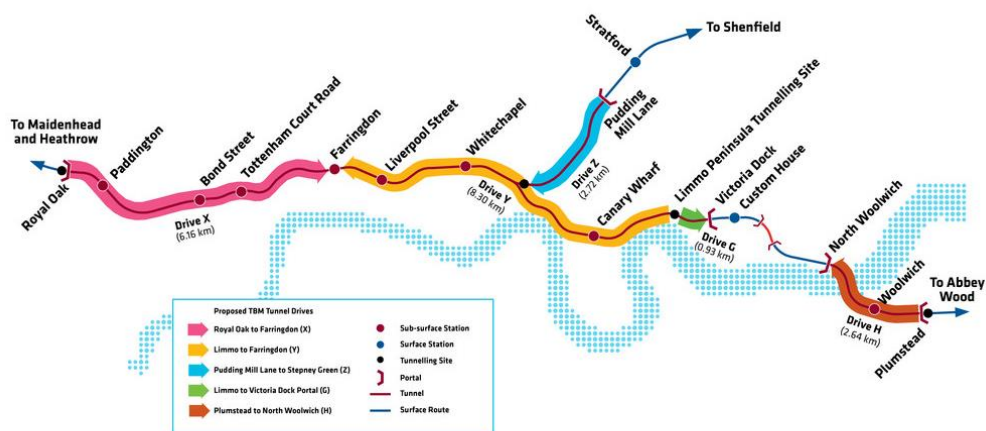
Tramos de túneles del Crossrail. Fuente: Crossrail.
